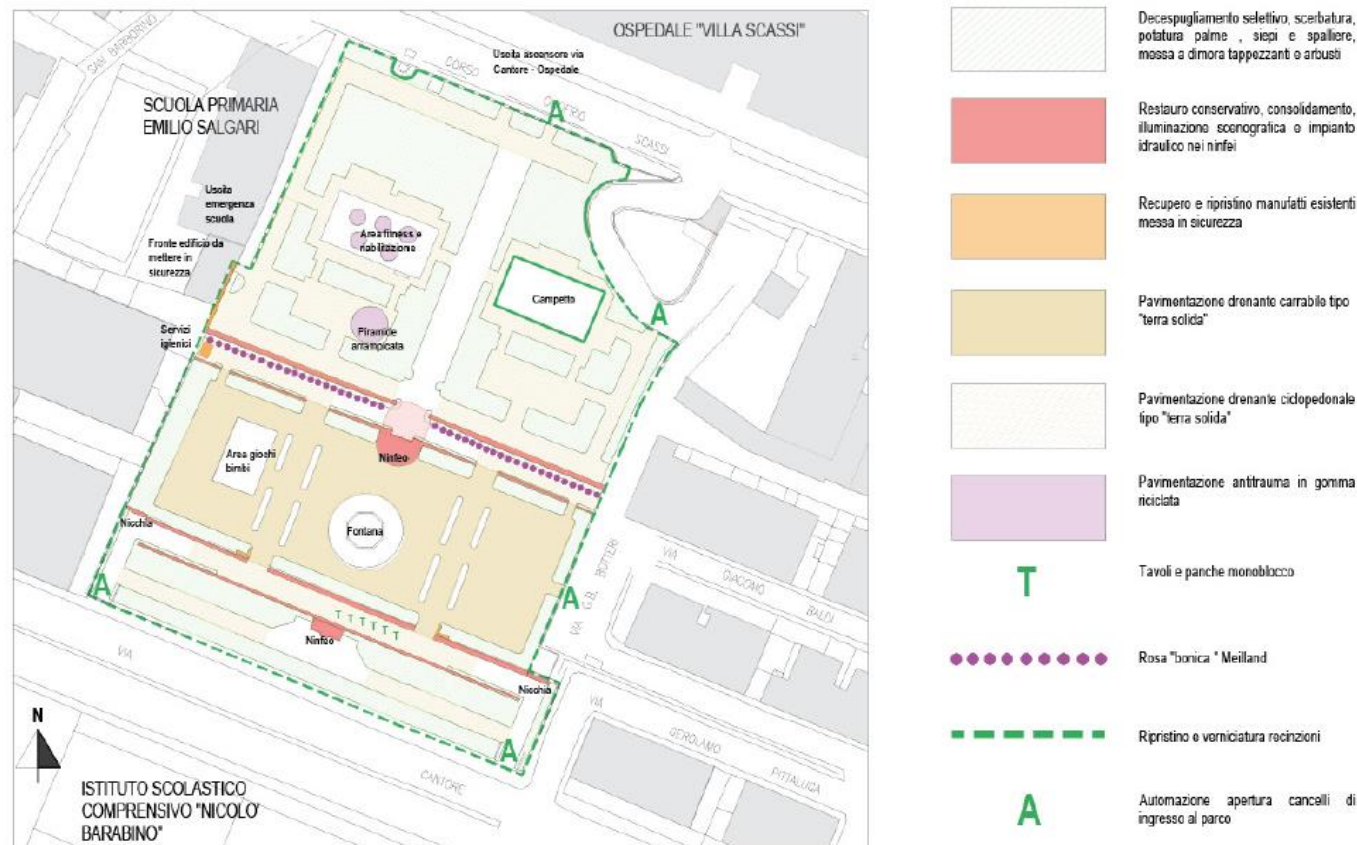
Planimetria area di intervento parco storico di Villa imperiale Scassi
